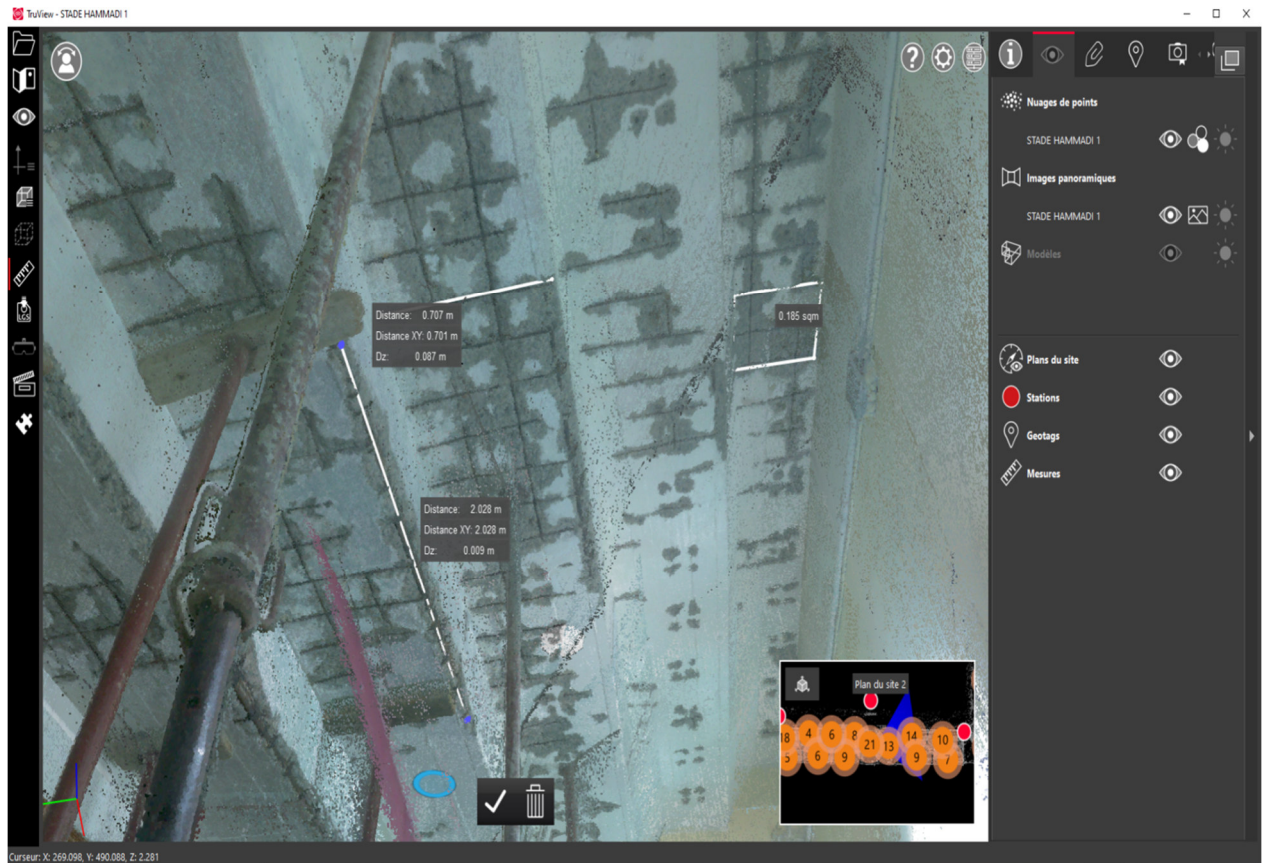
Dimensions du plafond de la salle stade Omar Hamadi.
